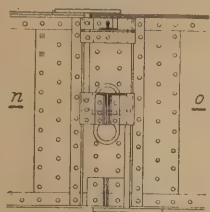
Bewegliches Lager links beim äußeren und rechts beim mittleren Hauptträger.
